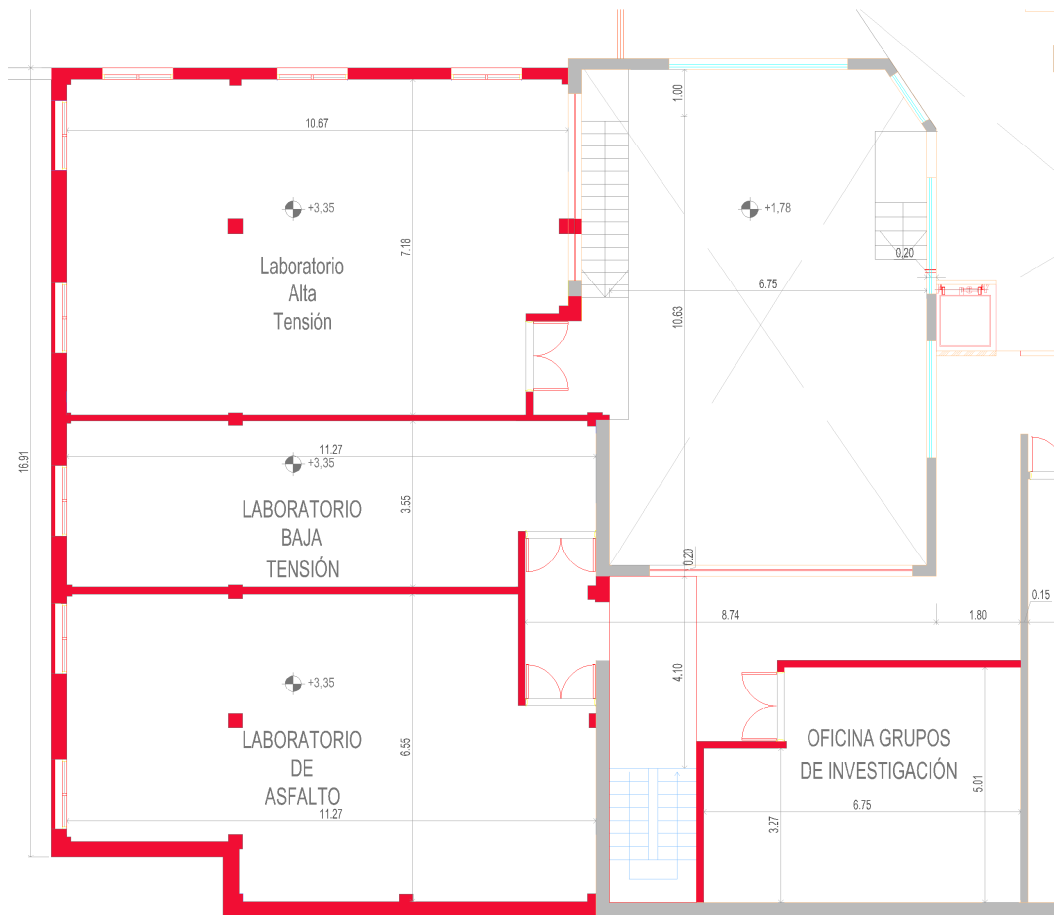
NUEVA PLANTA PRIMER PISO – LABORATORIOS U.T.N.
